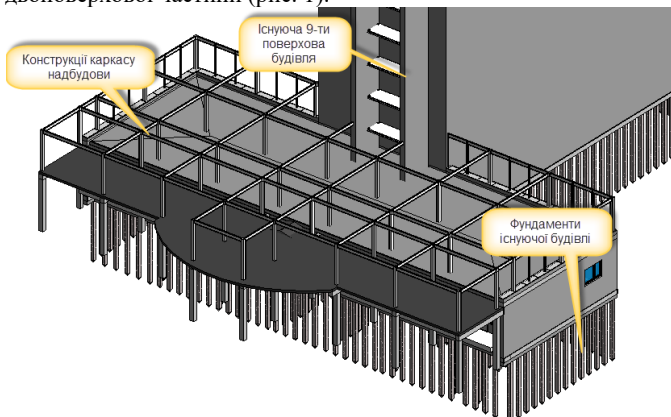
Інформаційна модель існуючої будівлі на стадії монтажу каркасу
